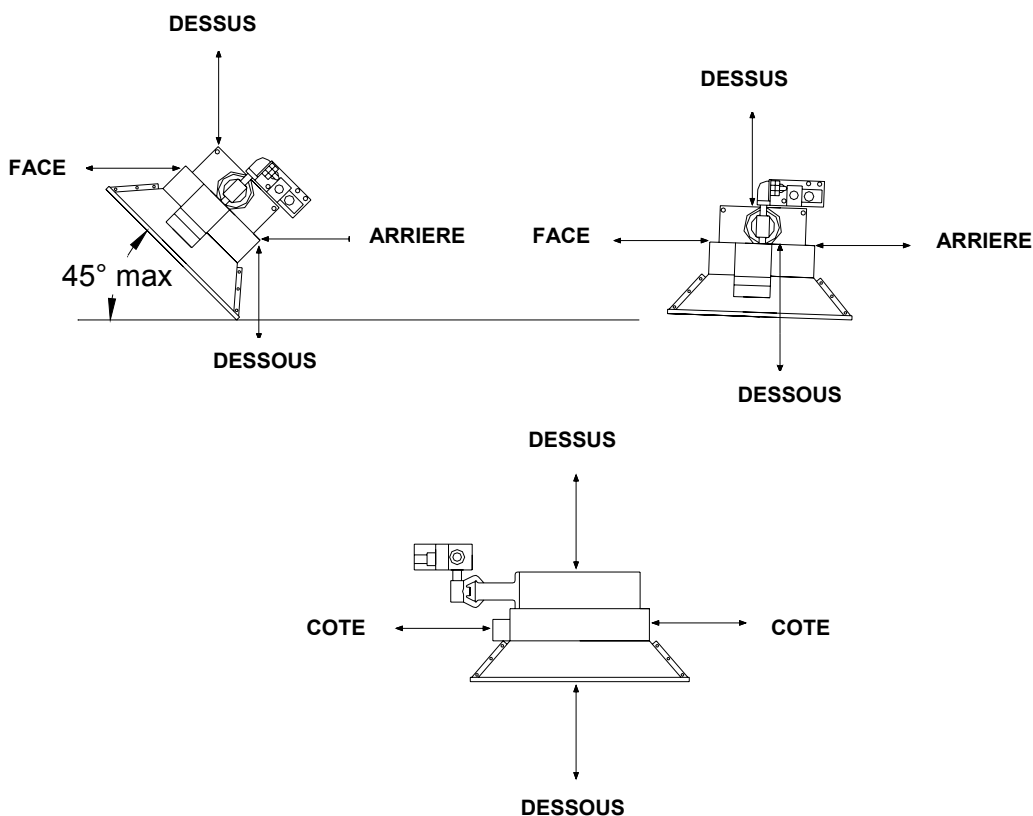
Hauteurs minimales d'installation – hauteur d'installation minimum par rapport au sol :
